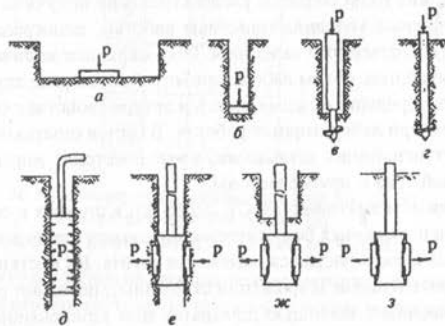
Схемы штамповых испытаний грунта в скважинах и шурфах: а — плоским штампом в шурфе; б — то же в забое буровой скважины; в — винтовым штампом ниже забоя буровой скважины; г — то же в массиве; д — радиальным прессиометром; е — лопастным прессиометром в стенке скважины; ж — то же ниже забоя буровой скважины; з — то же в массиве.
